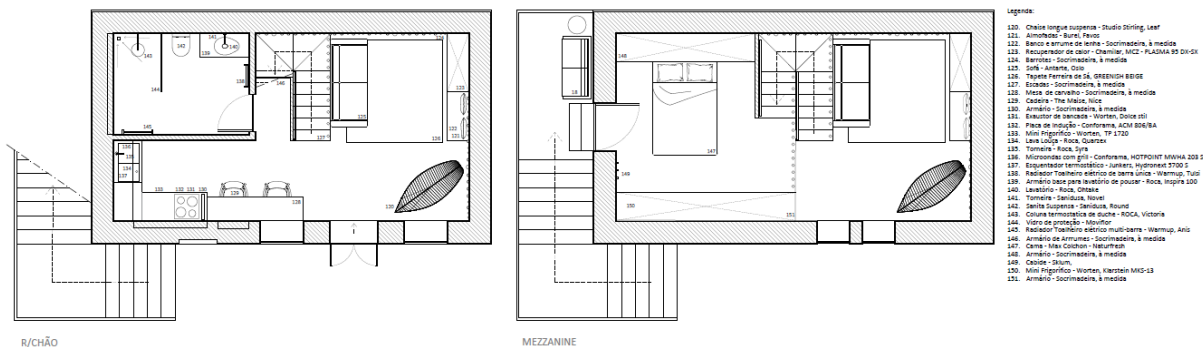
Planta de Equipamento e Mobiliário, Alojamento Til, Piso 1.
